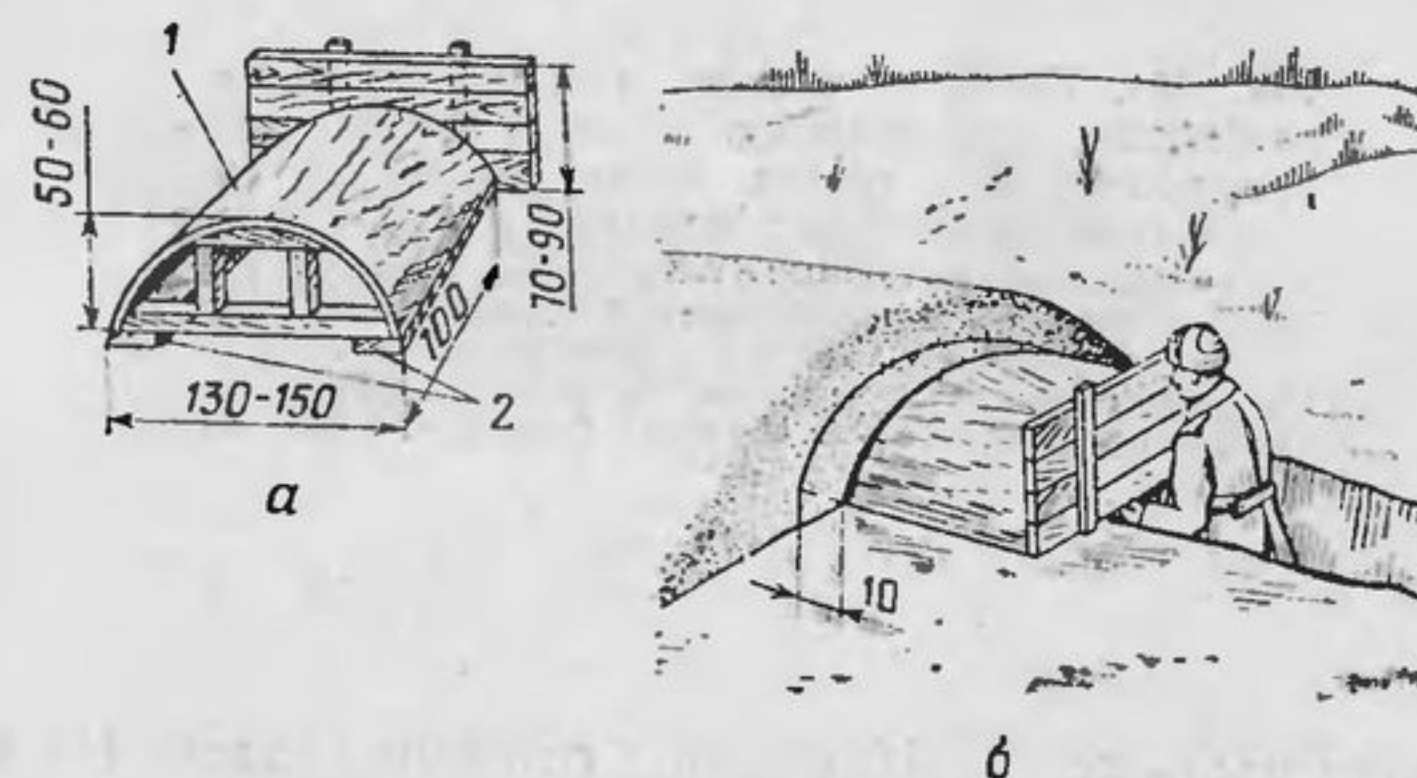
Устройство свода из снега с помощью передвижной опалубки:
